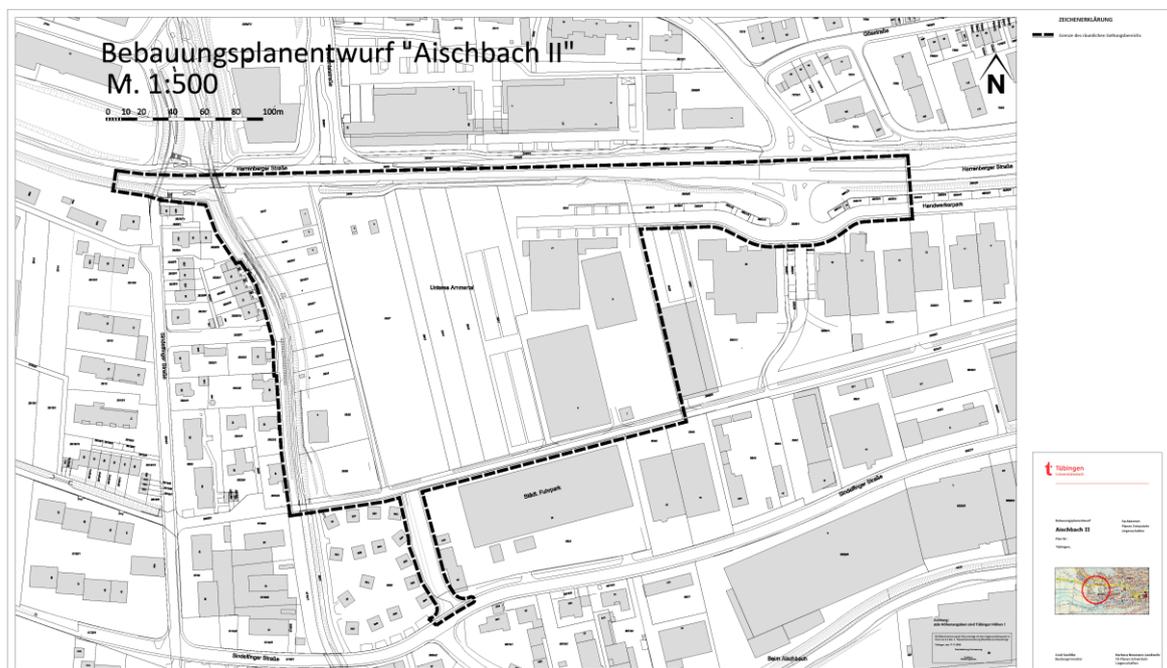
Plangebiet B-Plan „Aischbach II“, Tübingen Weststadt.
